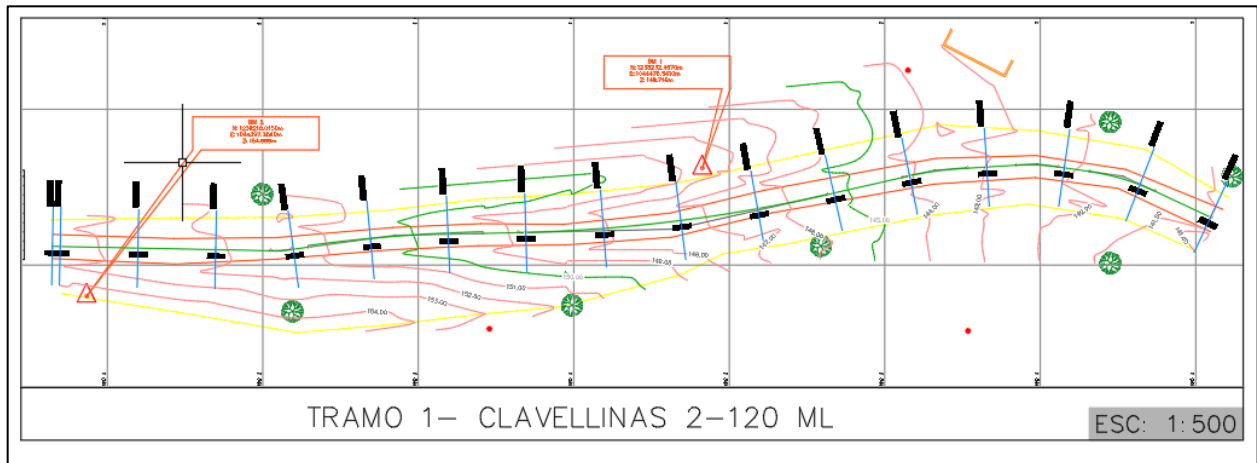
Imagen de planta del tramo 1 del proyecto de San Vicente de Chucuri-Santander
